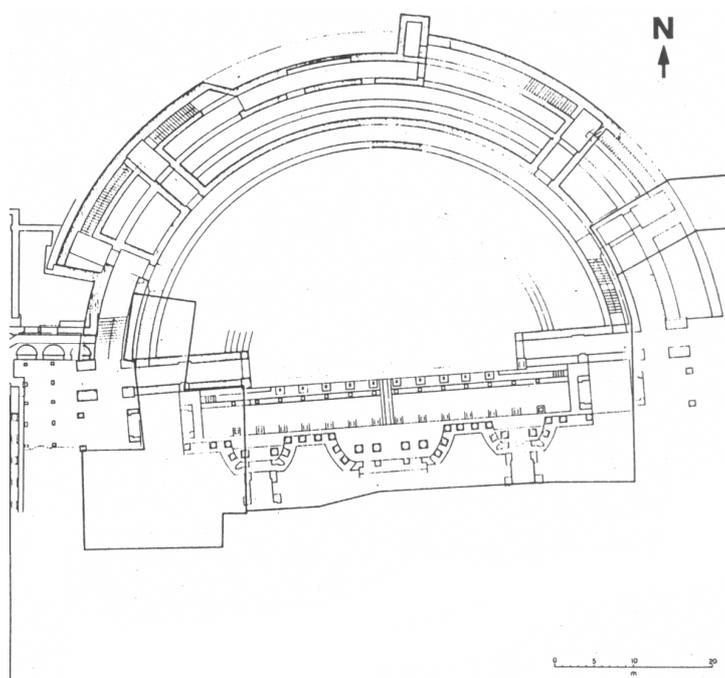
pianta schematica del teatro di Brescia e dell'aula a pilastri
